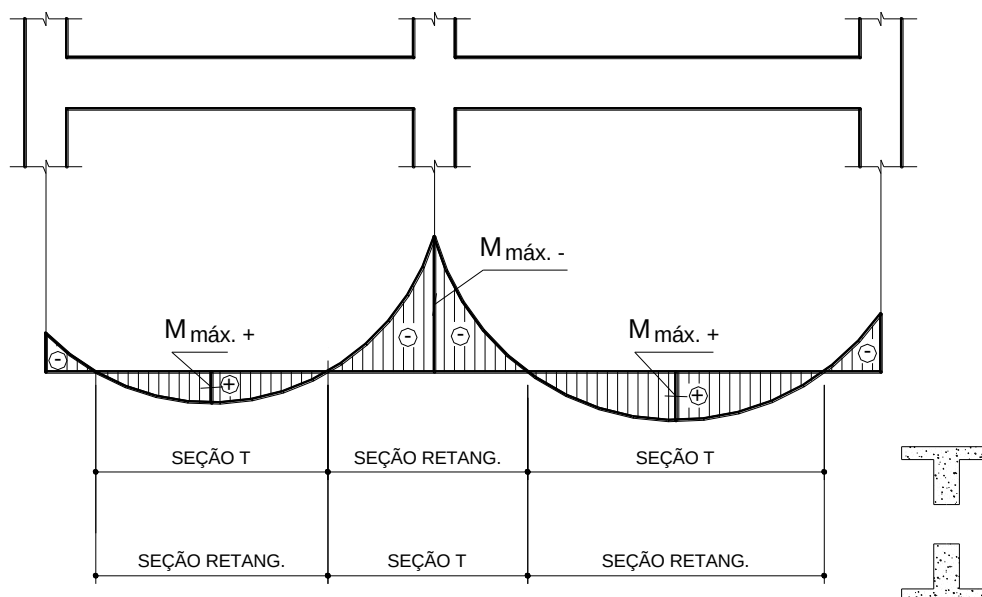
Consideração de seção retangular ou T em viga contínua com lajes adjacentes nas bordas inferior ou superior.
